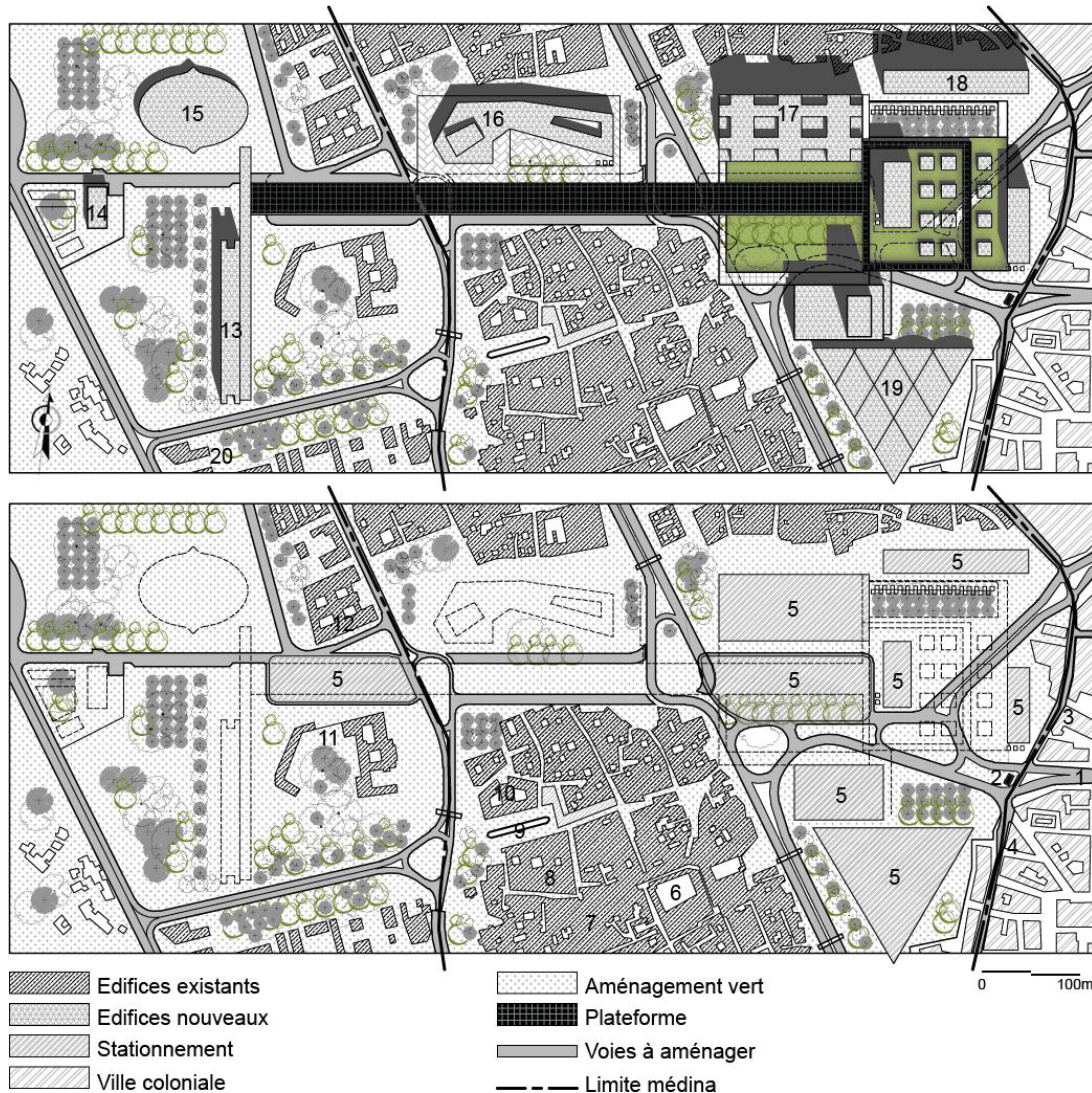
La voie conçue par l'équipe belge – Plan masse
